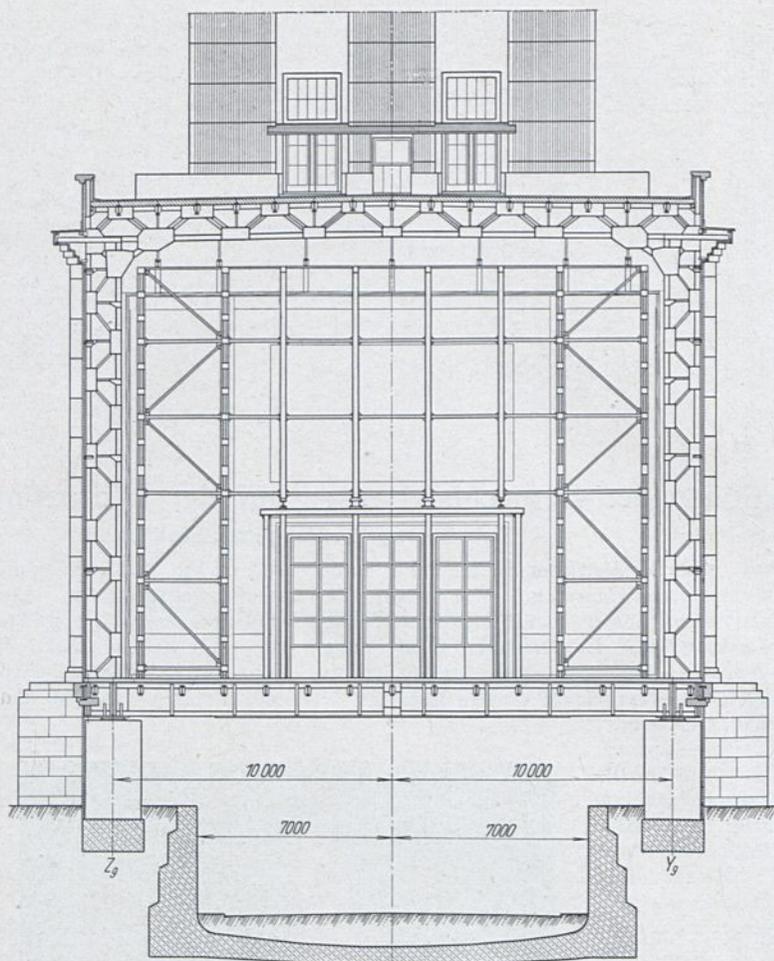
Querschnitt durch die Halle zwischen (9) und (10), Decke über der Avenue de Tokio.
